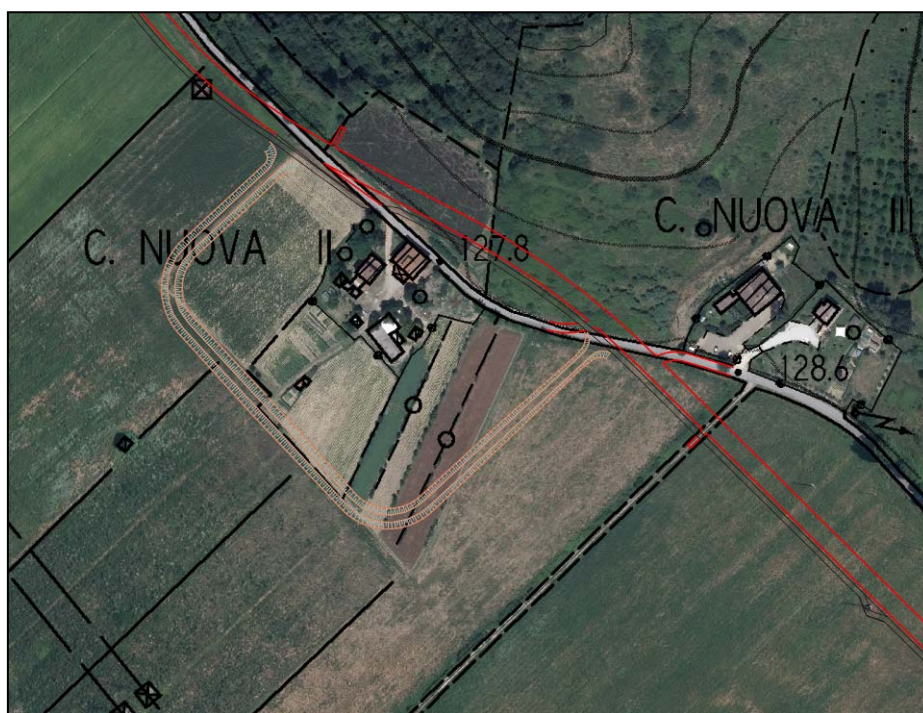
Argine Casanuova II estratto da planimetria di progetto.
